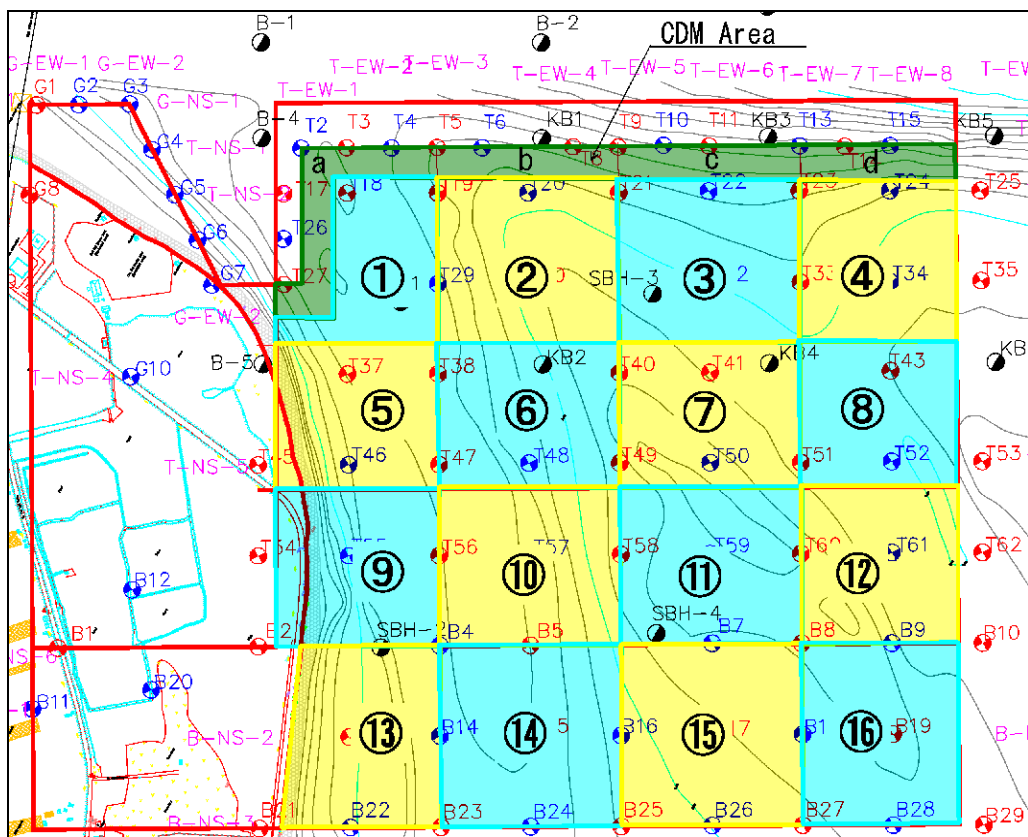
Mô hình để tính toán kiểm tra (Dải đất sát sau tường chắn đất)
